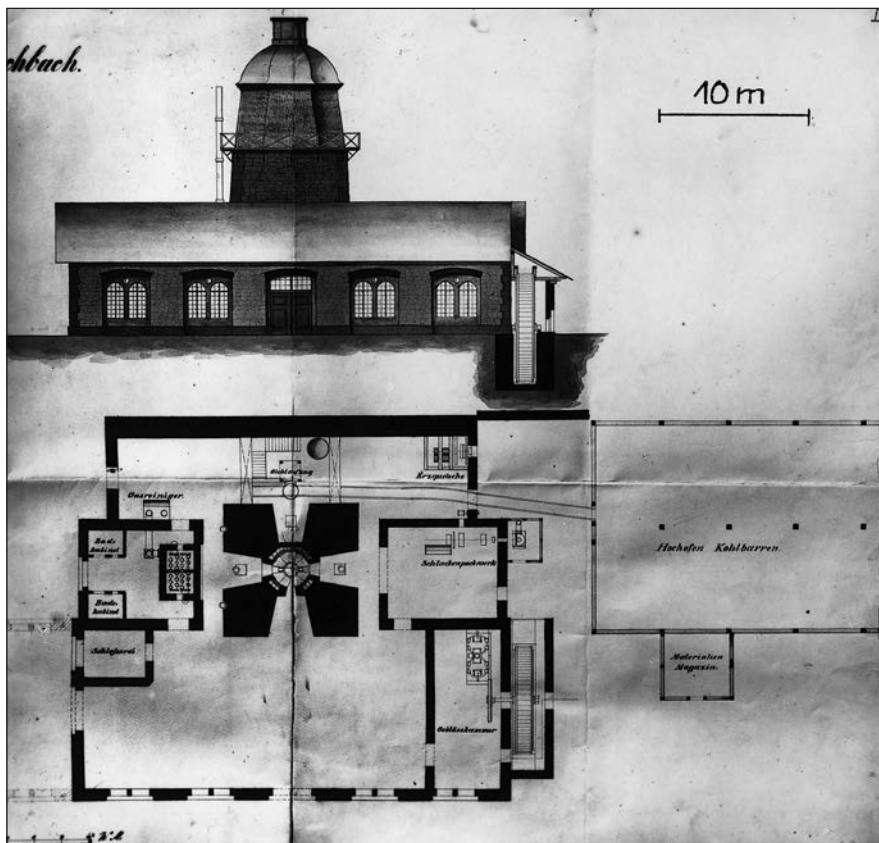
Aschbach, Hochofenwerk „Marienhütte“. Hüttengebäude mit Hochofen (Ansicht und Grundriss), um 1855/60 (?)
